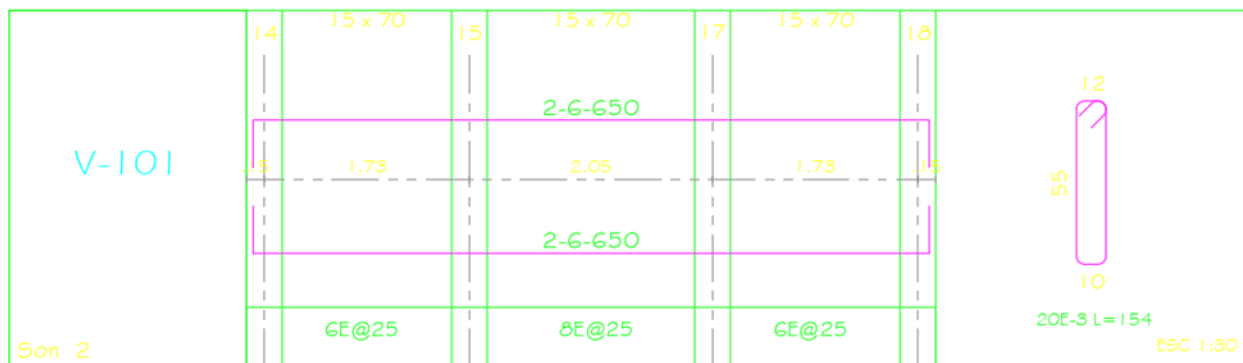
Despiece de vigueta V-101 de losa de cimentación.
